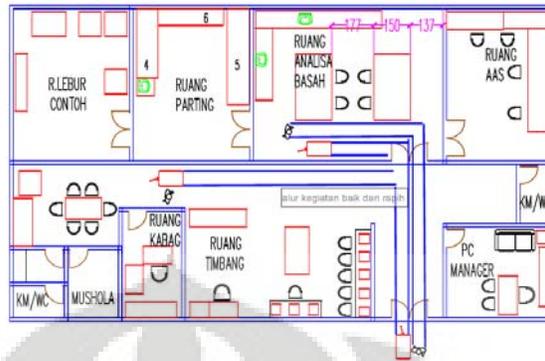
Layout ruang Lab Analisa sebelum perbaikan
